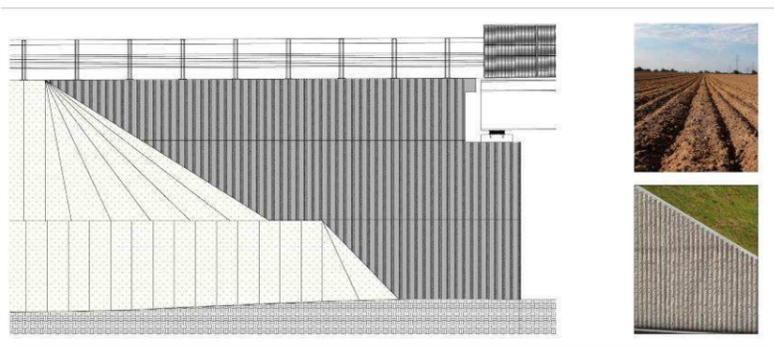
Spalla del ponte Zona Industriale San Zeno.
